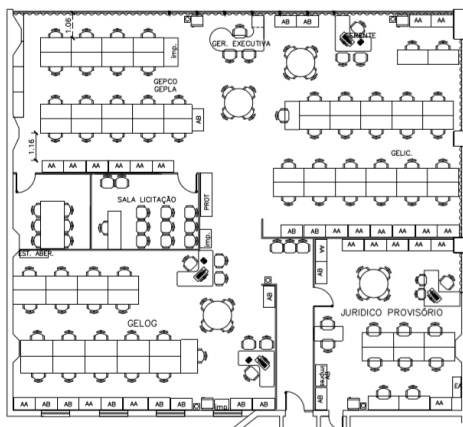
Novo layout no padrão planta livre. Fonte: Elaborado pelas autoras.
